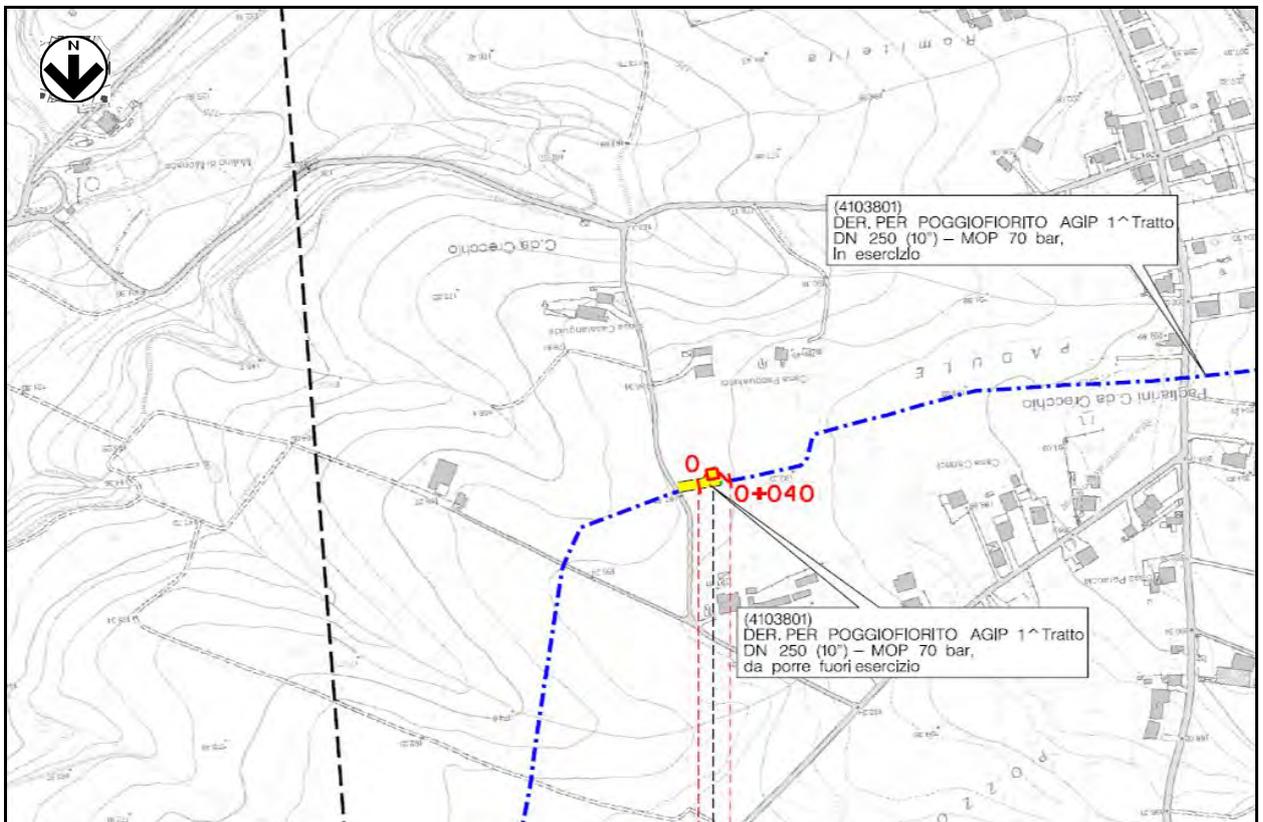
/C.b – Planimetria 1:5.000 con localizzazione dell'area dell'Intervento n.2 (progetto in rosso, dismissione in verde, esistente in blu)
